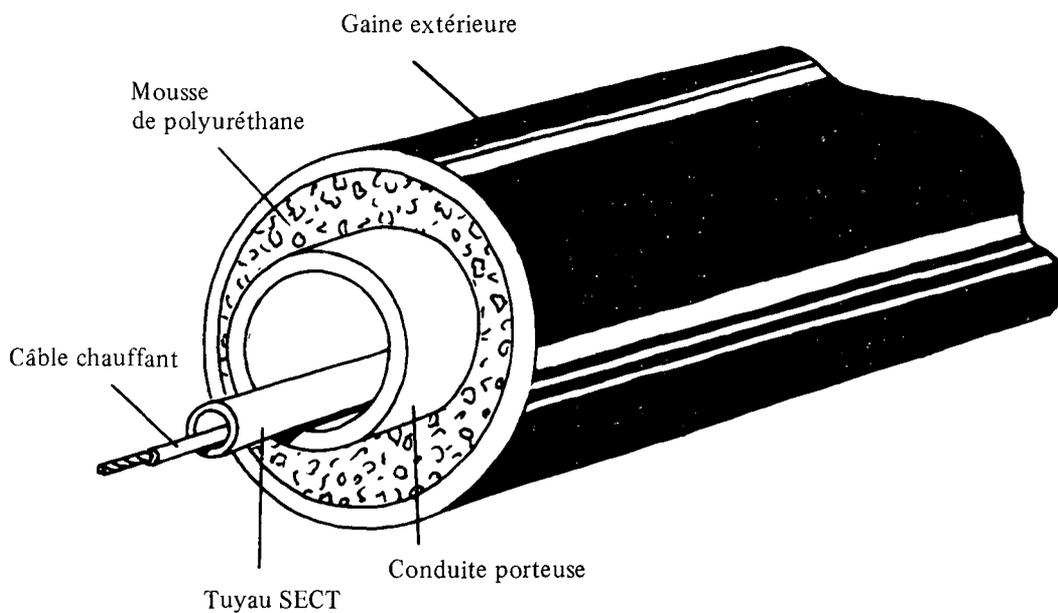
Tuyau SECT à l'intérieur d'une conduite porteuse
